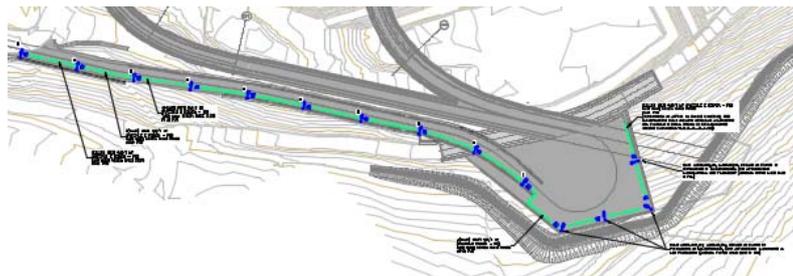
Planimetria impianto illuminazione piazzale manovra e strada di collegamento
